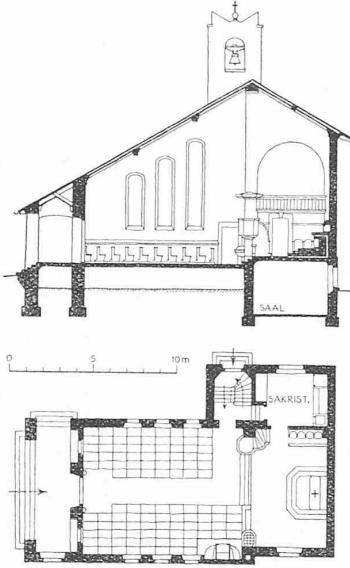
Grundriss und Längsschnitt 1:400 einer Kapelle im Berner Oberland; Abb. 2 Schaubild dazu.
